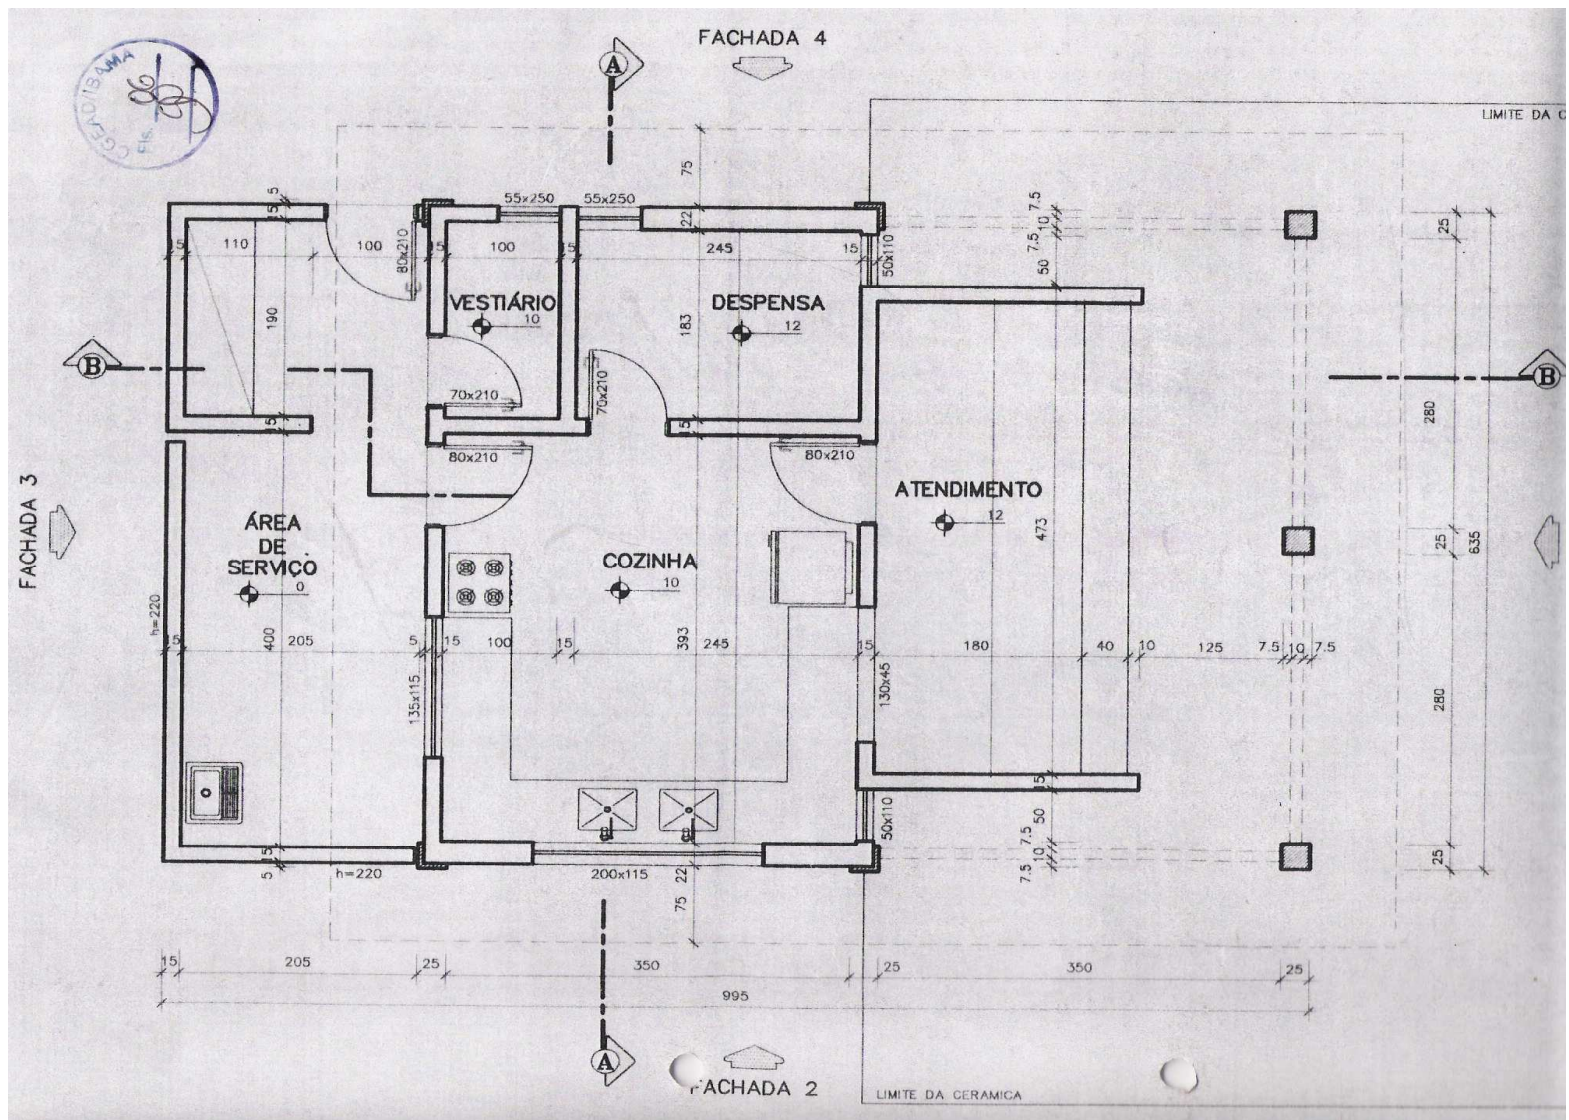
Planta baixa da lancheonete da Piscina Pedreira.
